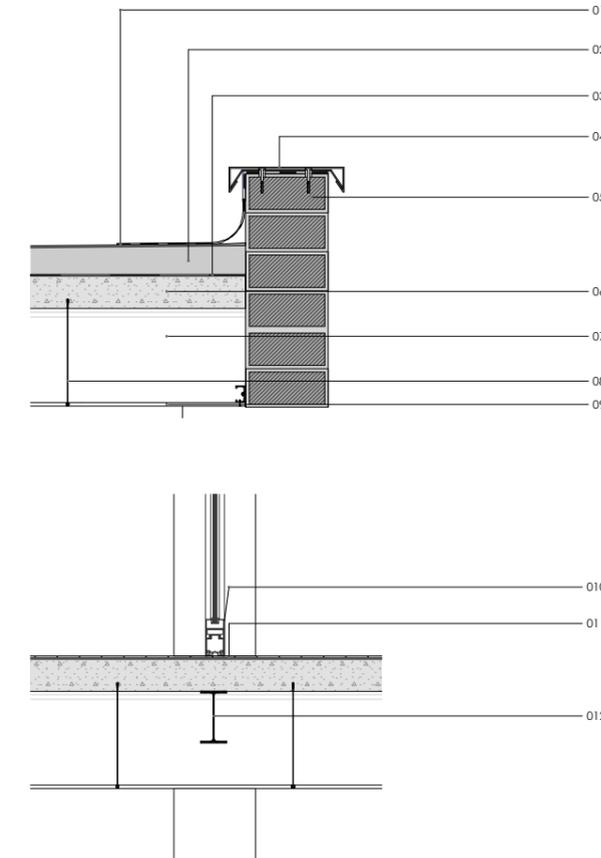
Detalle 01-02 escala 1:10 Fuente: Elaboración propia.
